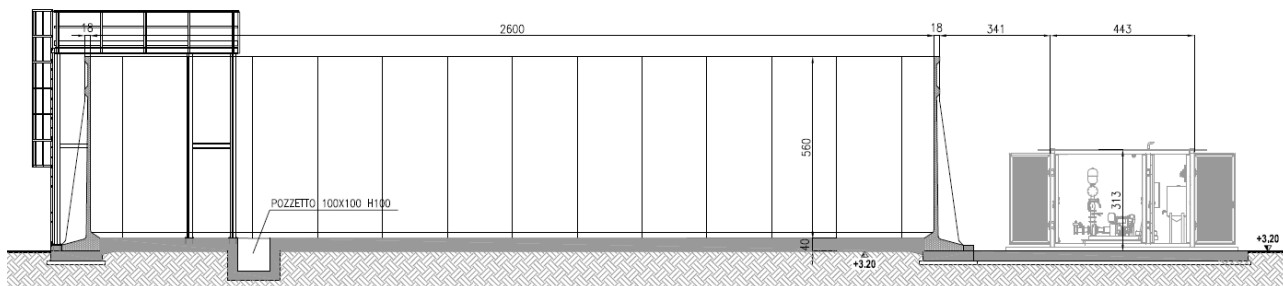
Vasca antincendio: prospetto (stralcio 090026-ENG-D-DA-3042 - Vasca antincendio - Pianta fondazioni, pianta coperture, sezioni e prospetti)
